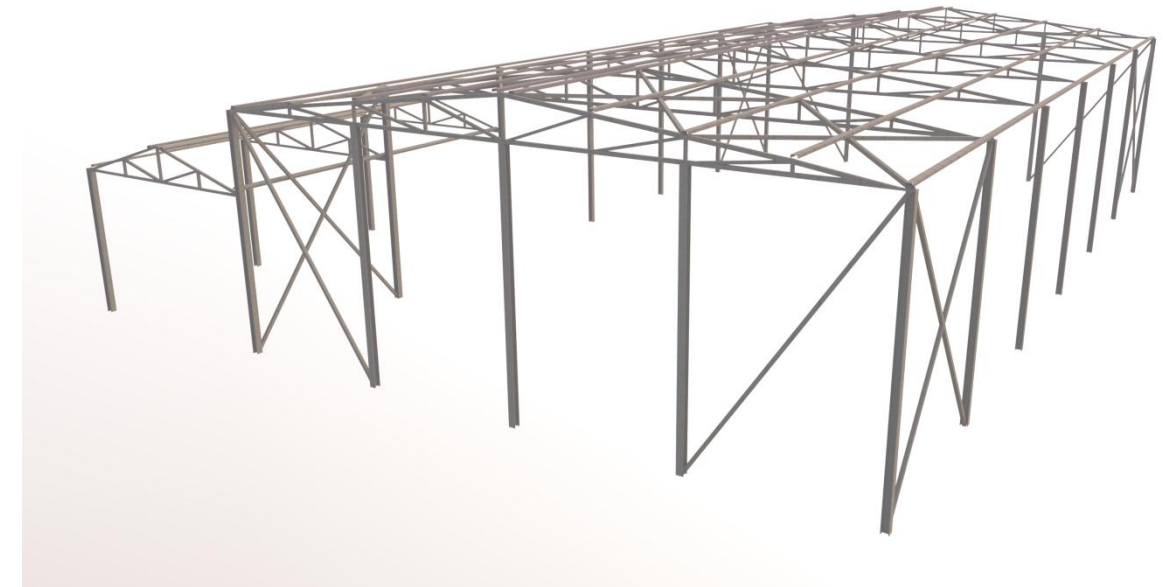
Modelo estructural de la solución con celosía tipo Pratt metálica a dos aguas. Vista 2
